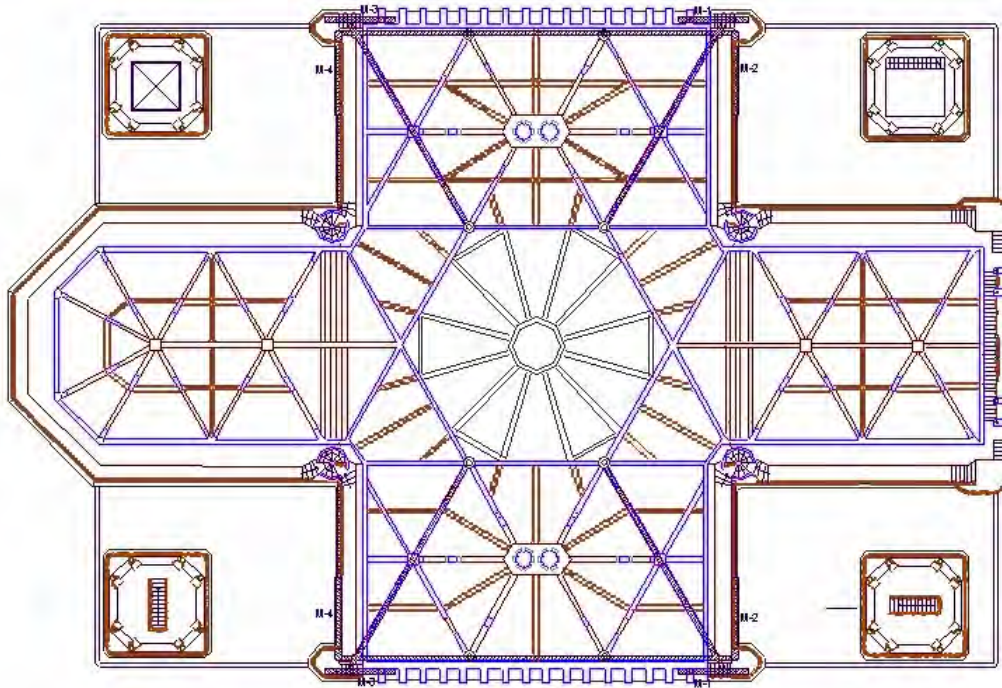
Planta de intervenciones de muros y vigas a nivel de cubierta
